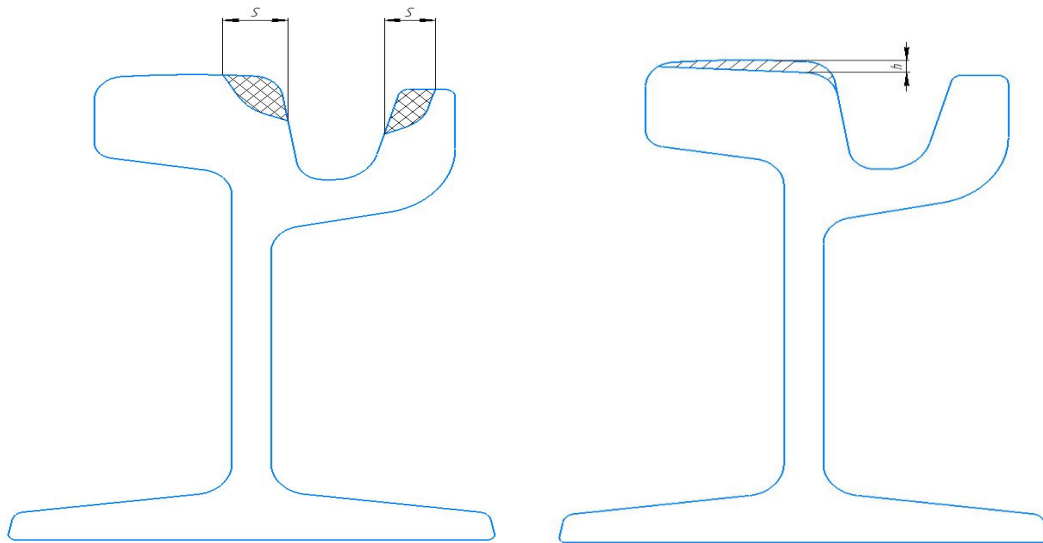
Боковой и вертикальный износ головки и губки трамвайных рельсов
